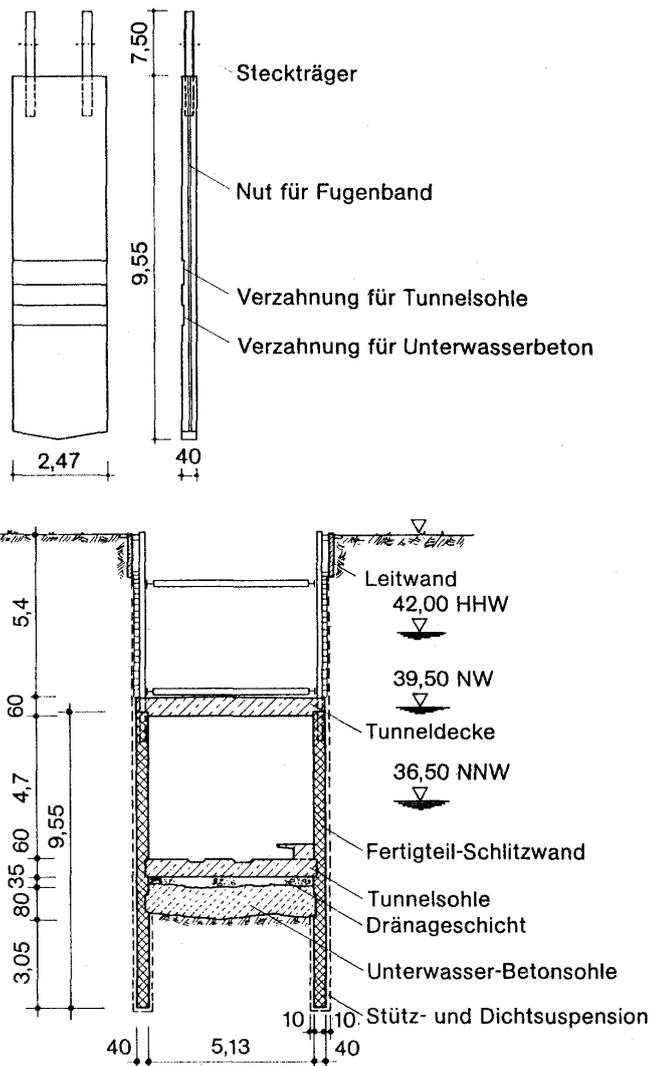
Tunnel mit Stahlbetonfertigteilen, U-Bahn Köln, Baulos 1D
